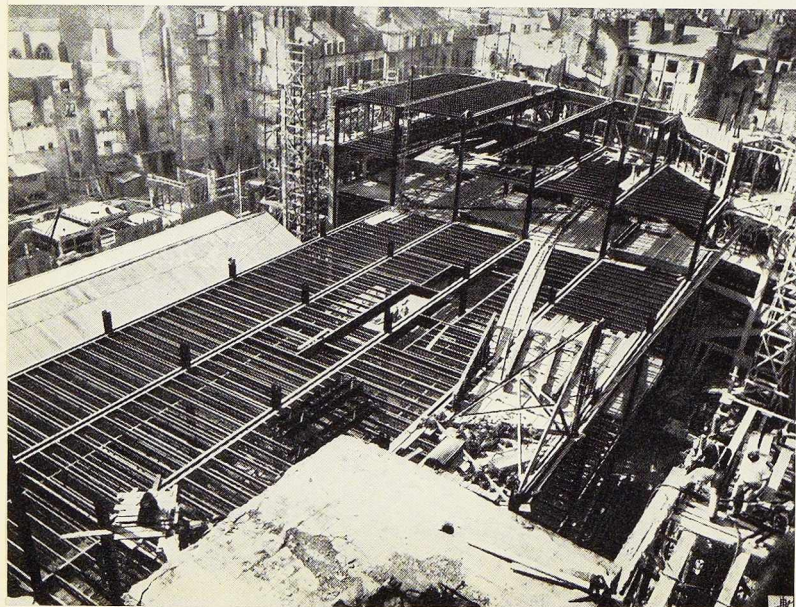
Vue du chantier pendant le montage de l'ossature métallique, sur la partie gauche, les bâtiments provisoires situés en bordure de rue.
